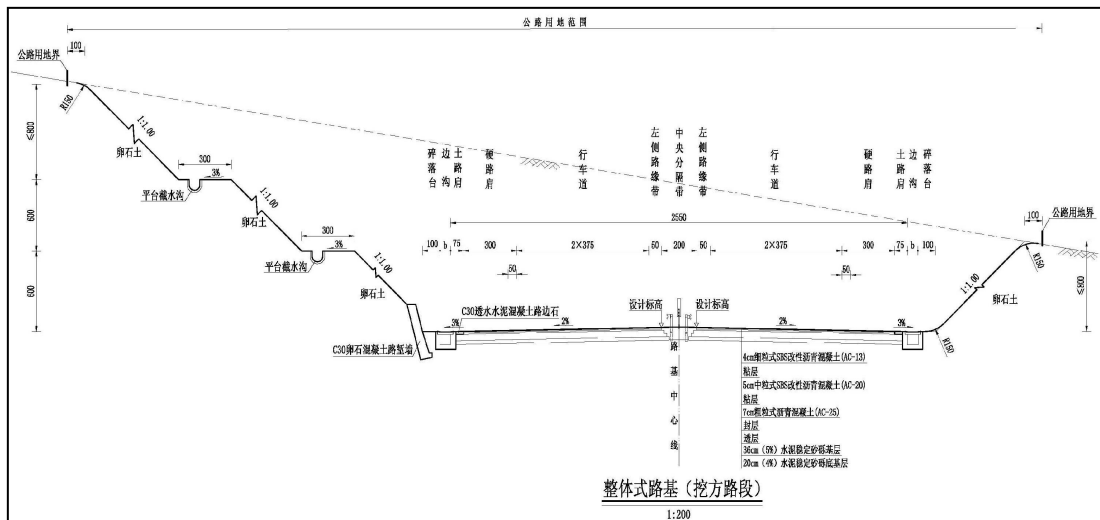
标准路段 (挖方路段) 横断面示意图
